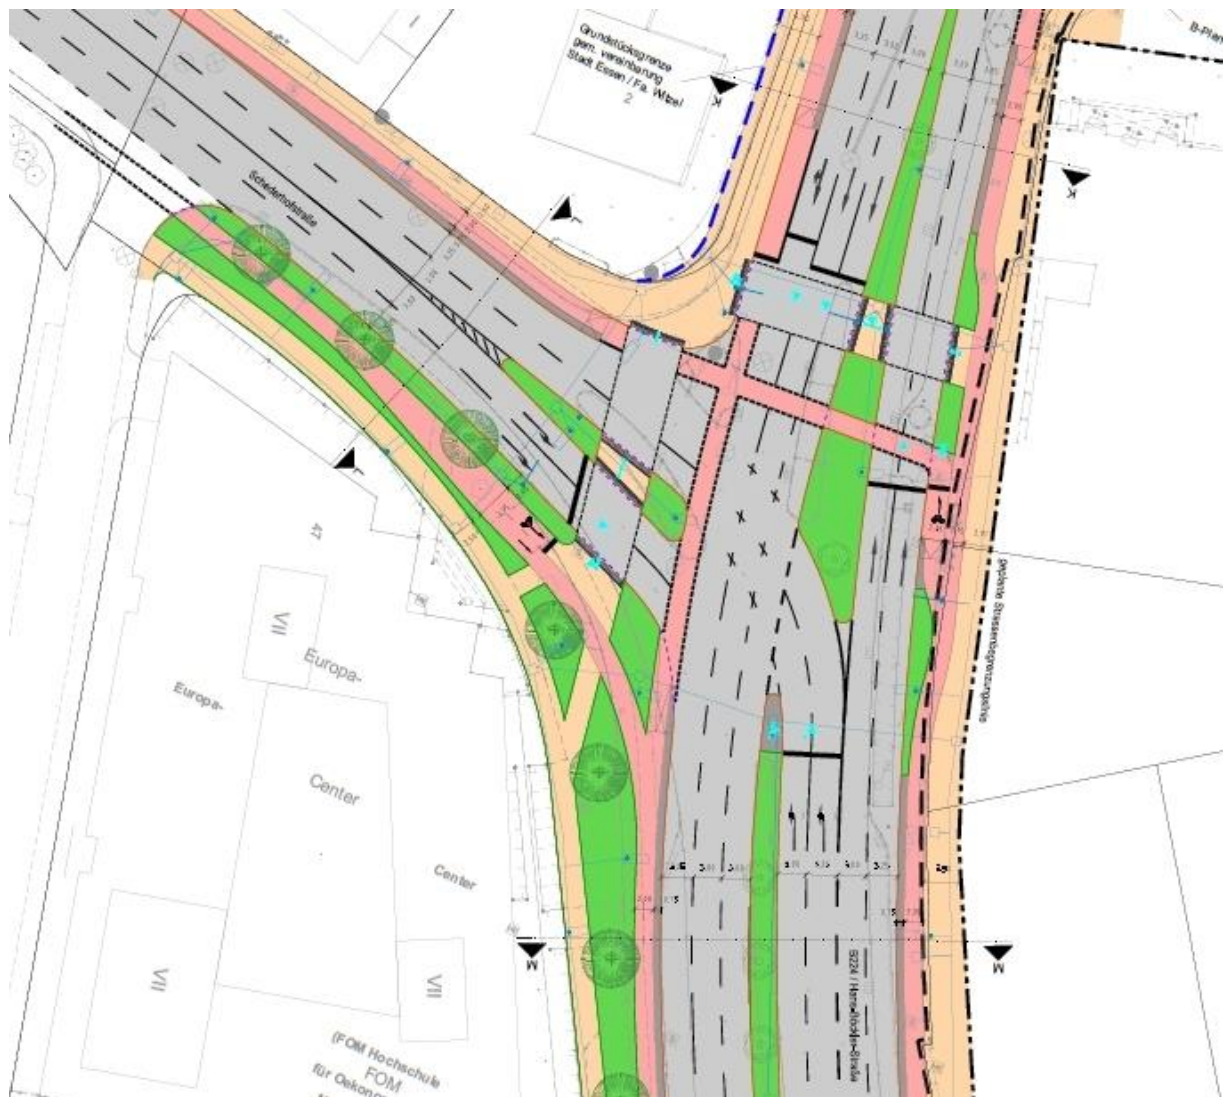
Lageplan Knoten Hans-Böckler-Straße / Friedrichstraße / Schederhofstraße
